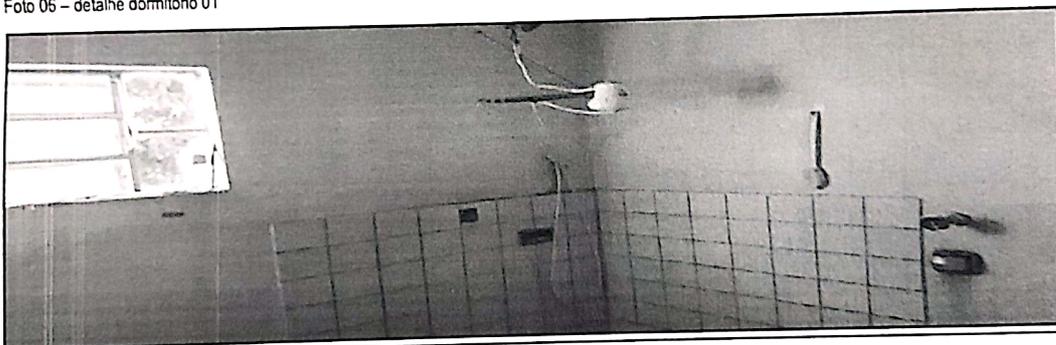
vista interna do banheiro – detalhe azulejo 1,40 m
